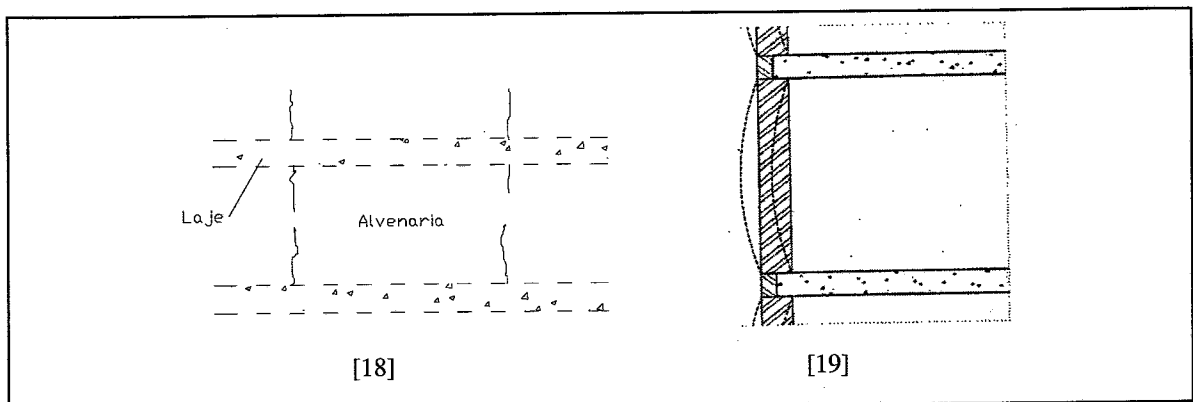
Fissuração em zona de laje por impedimento da deformação da alvenaria e encurvadura do pano de parede não confinado
